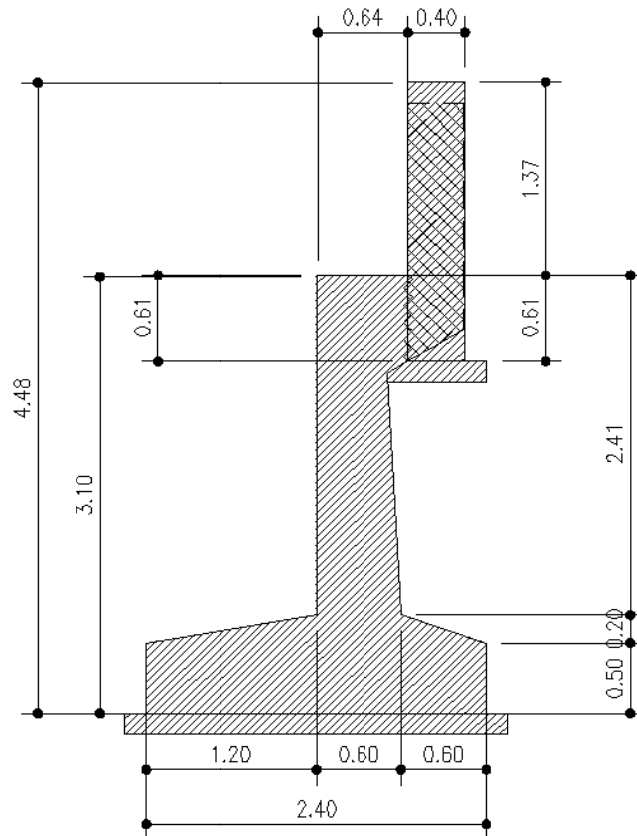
Geometria di calcolo spalla esistente
